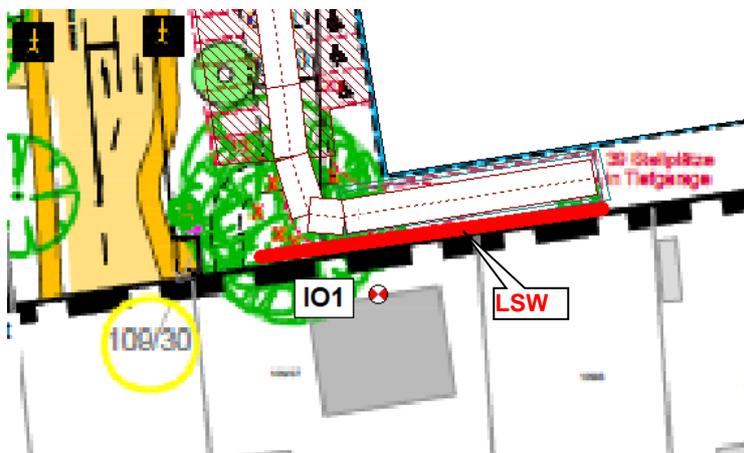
Lageplan mit der Darstellung der erforderlichen Lärmschutzwand (LSW) zum Schutz des benachbarten Wohngebäudes (Immissionsort IO1)
